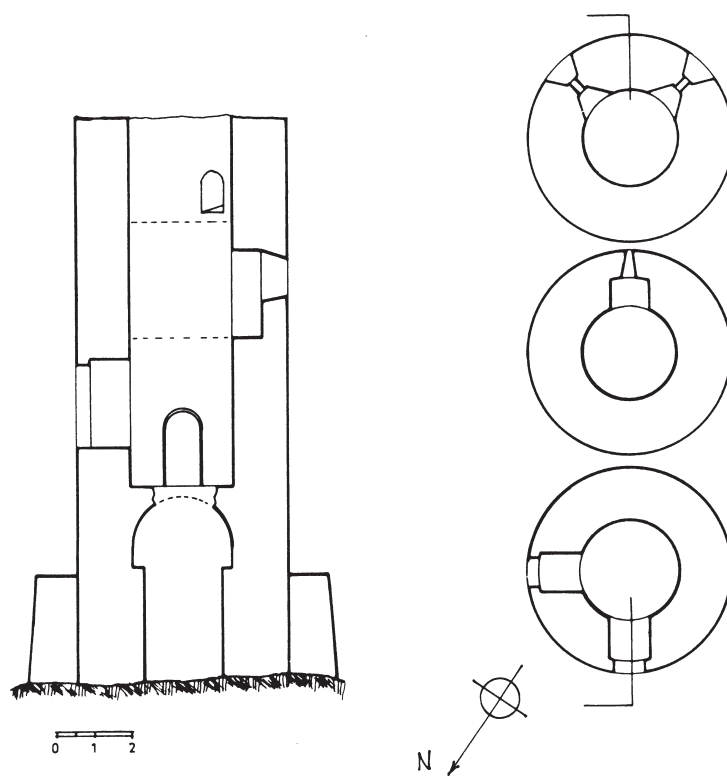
Planta i secció de la torre d'Alcamora (Pallars Jussà).
